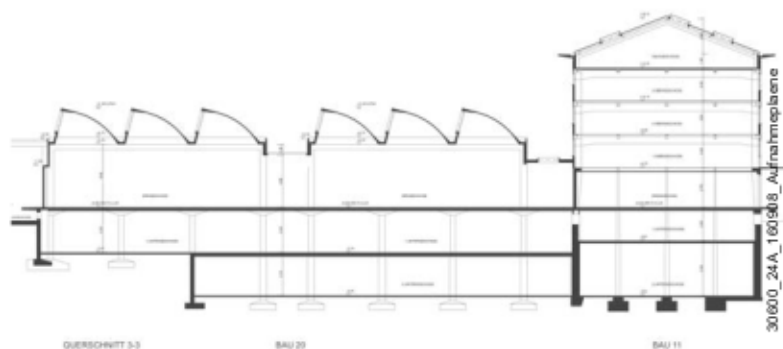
Bestand mit Sheddach über zwei Untergeschossen
